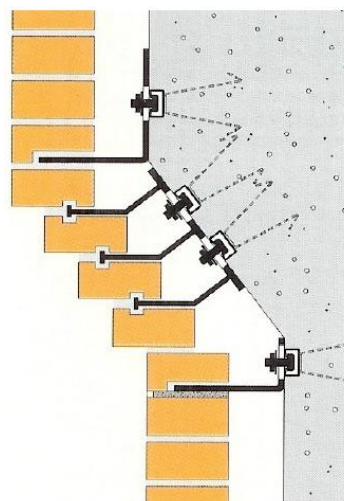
Fixação de tijolo com face à vista em parede de betão oblíqua [48]
